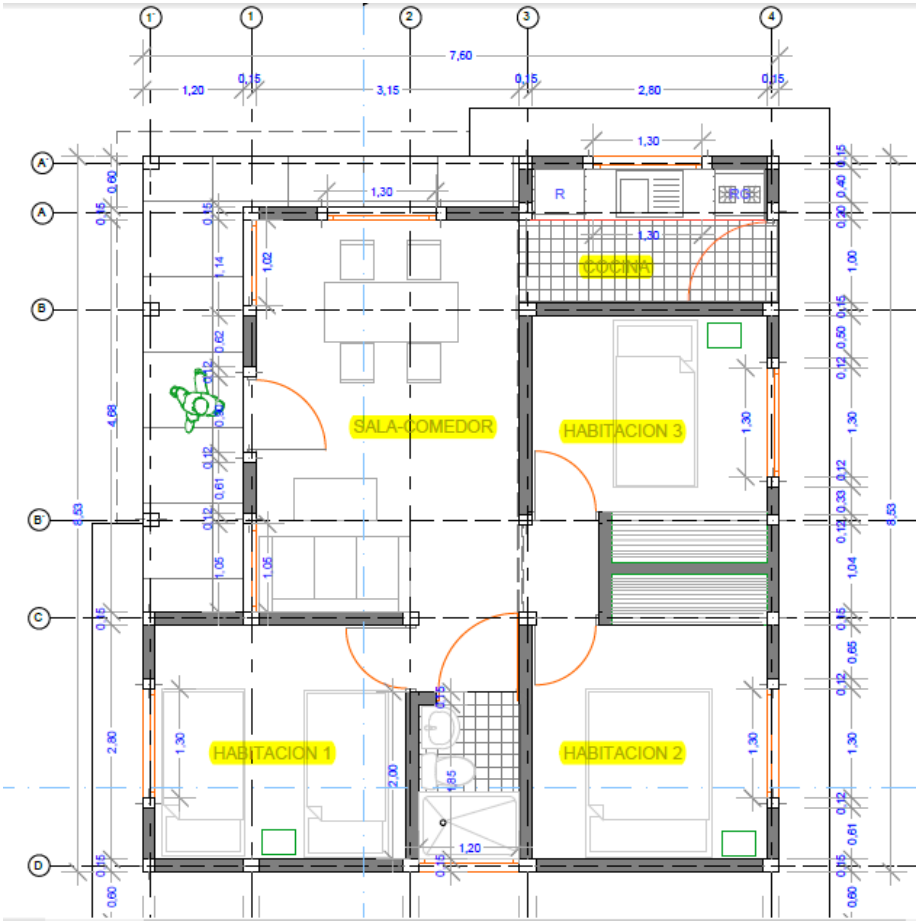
Planta Arquitectónica (FOMVIDU, 2015)
